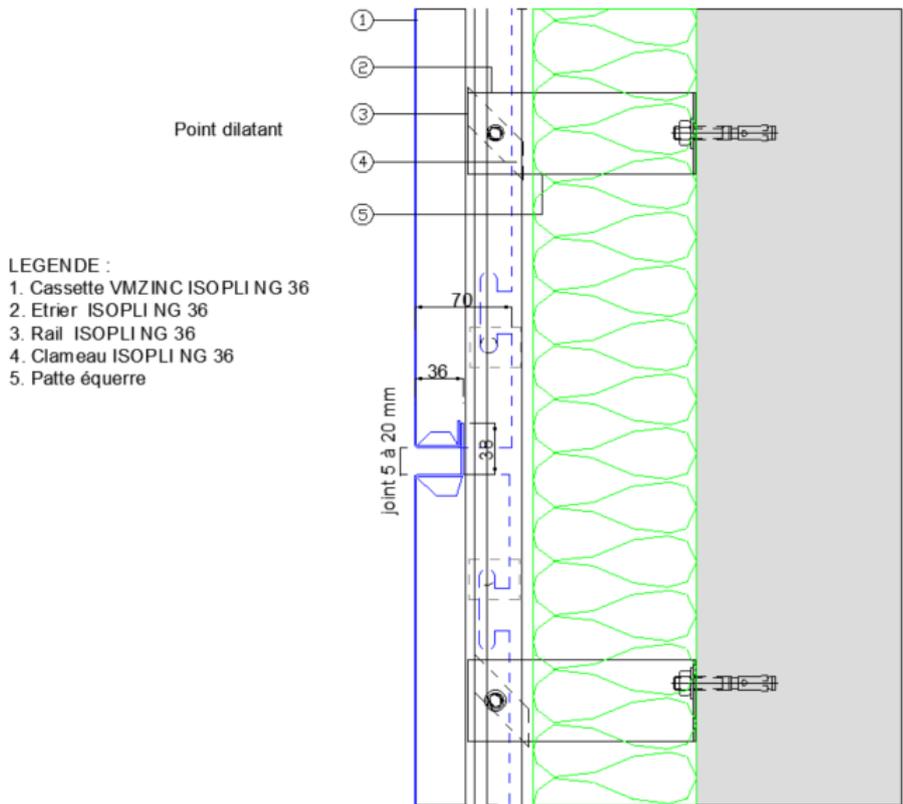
Joint horizontal (coupe verticale) avec rails ISOPLING de 3 m maximum
